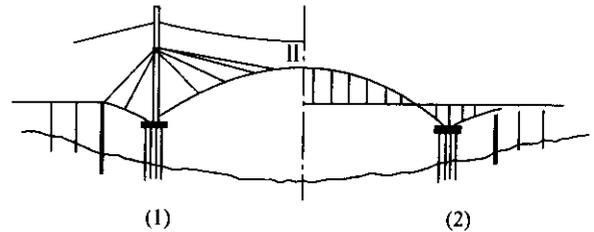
飞燕式的中承式钢管混凝土拱桥施工布置及立面
